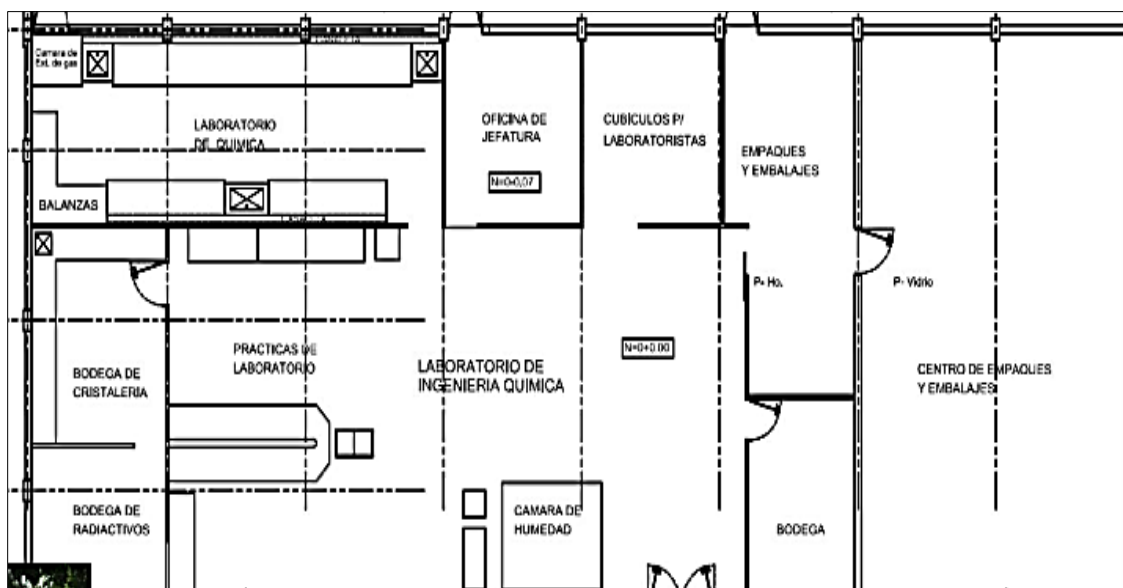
Distribución actual de los espacios. Plano superior del Laboratorio Planta Piloto de la EIQA – FIA – UES. Fuente: (Rodríguez y Cáceres, 2016)
